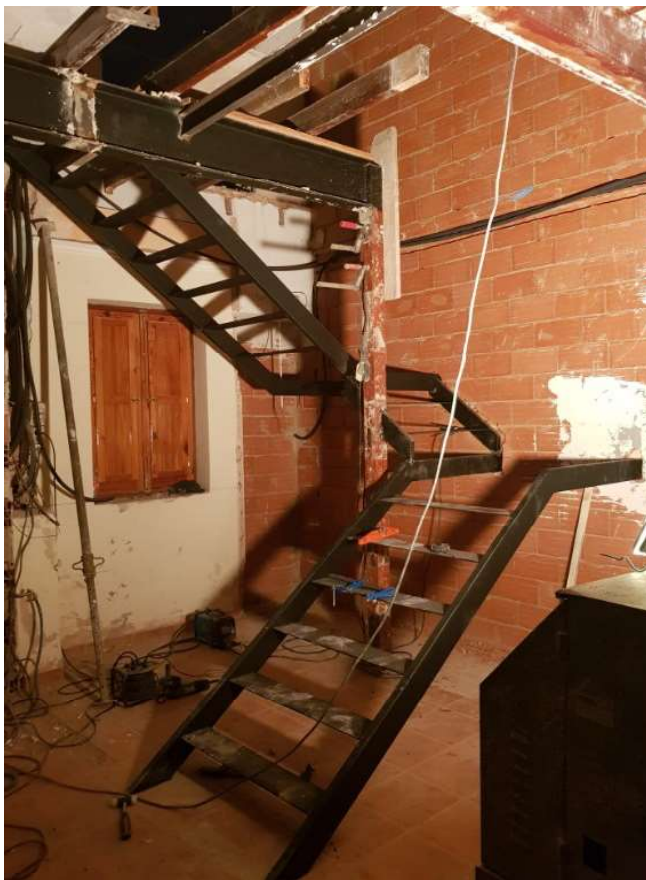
Montaje de estructura metálica de escalera (elaboración propia)
